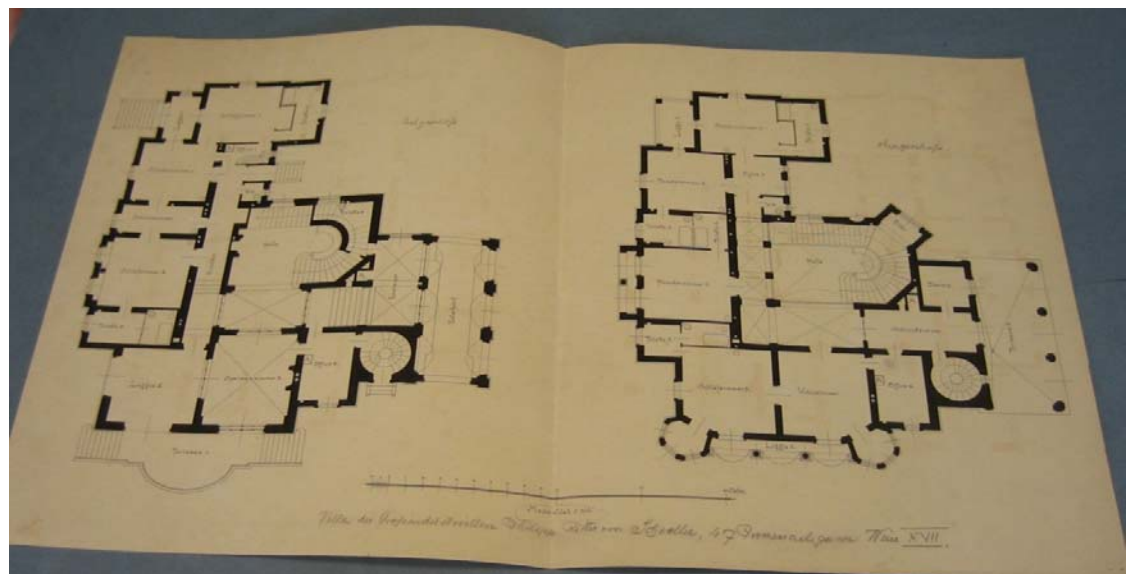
Grundriss Erdgeschoss / Erster Stock
